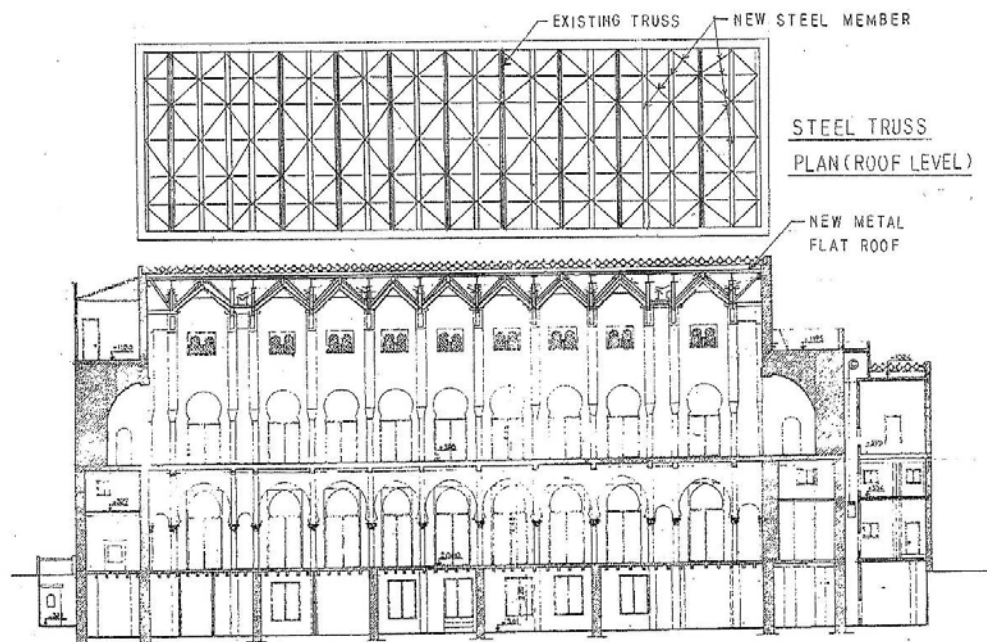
Plan et élévation de la toiture en treillis d'acier
